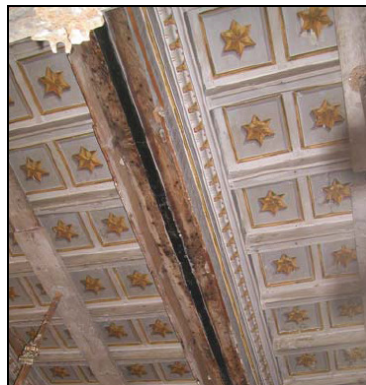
Vigas deterioradas. Fig.3.303 Aplicación del laminado. Fig. 3.304 Detalle del laminado.
